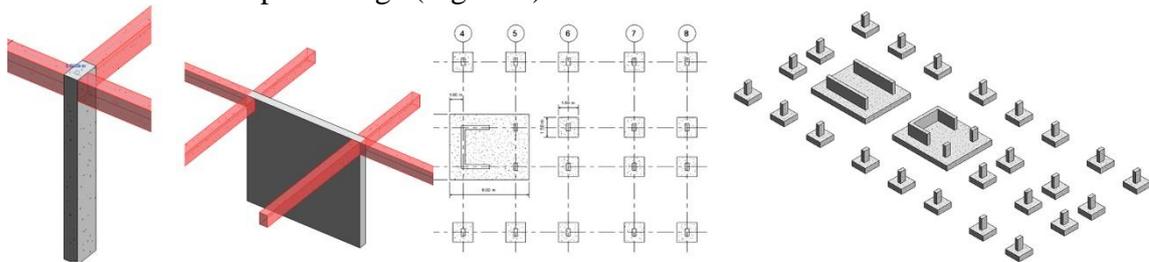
Intersecção entre elementos verticais e vigas e modelação de sapatas.
